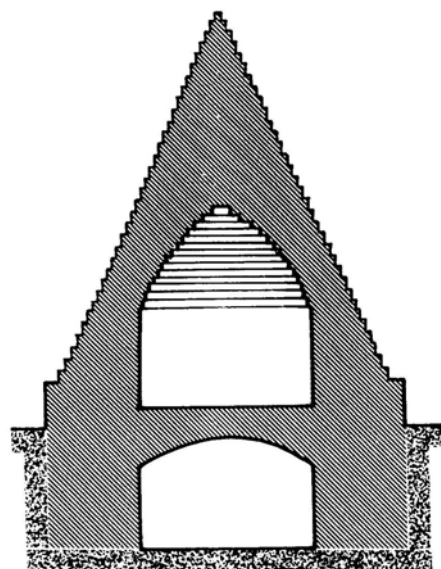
Reconstrucció d'una tomba de pou amb piràmide.
